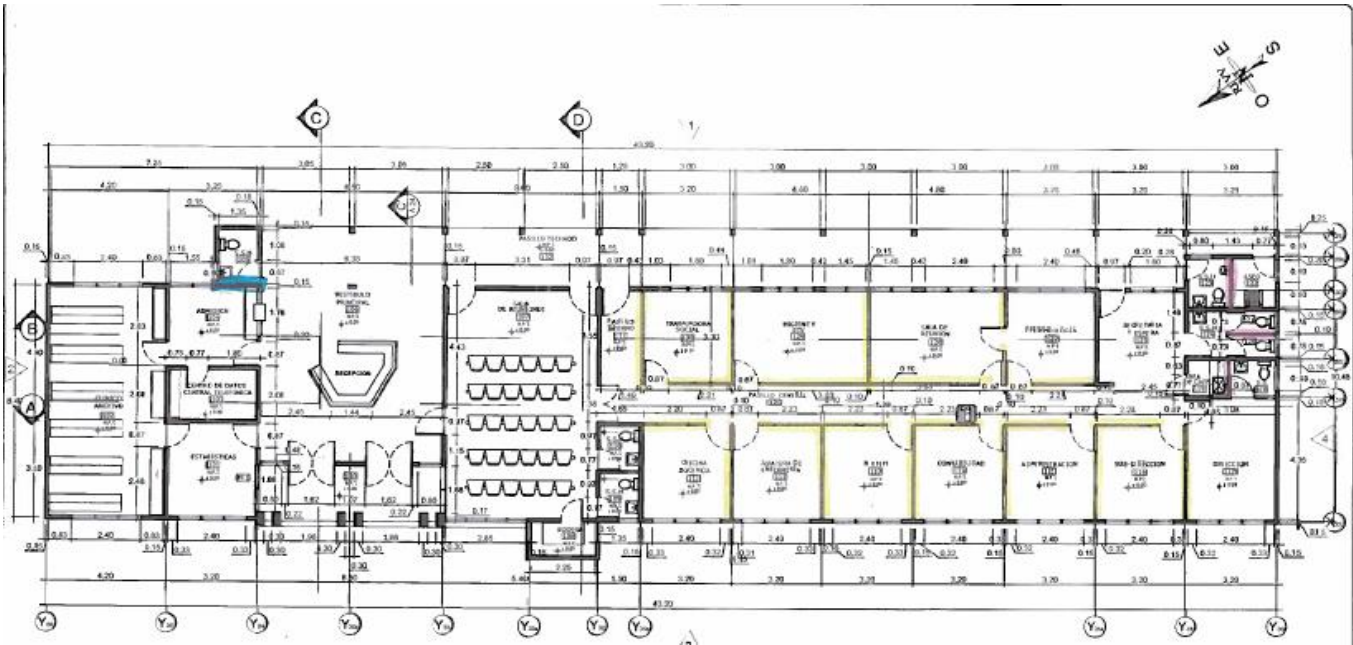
Lamina de planta arquitectónica de admón. ubicación de las etapas
